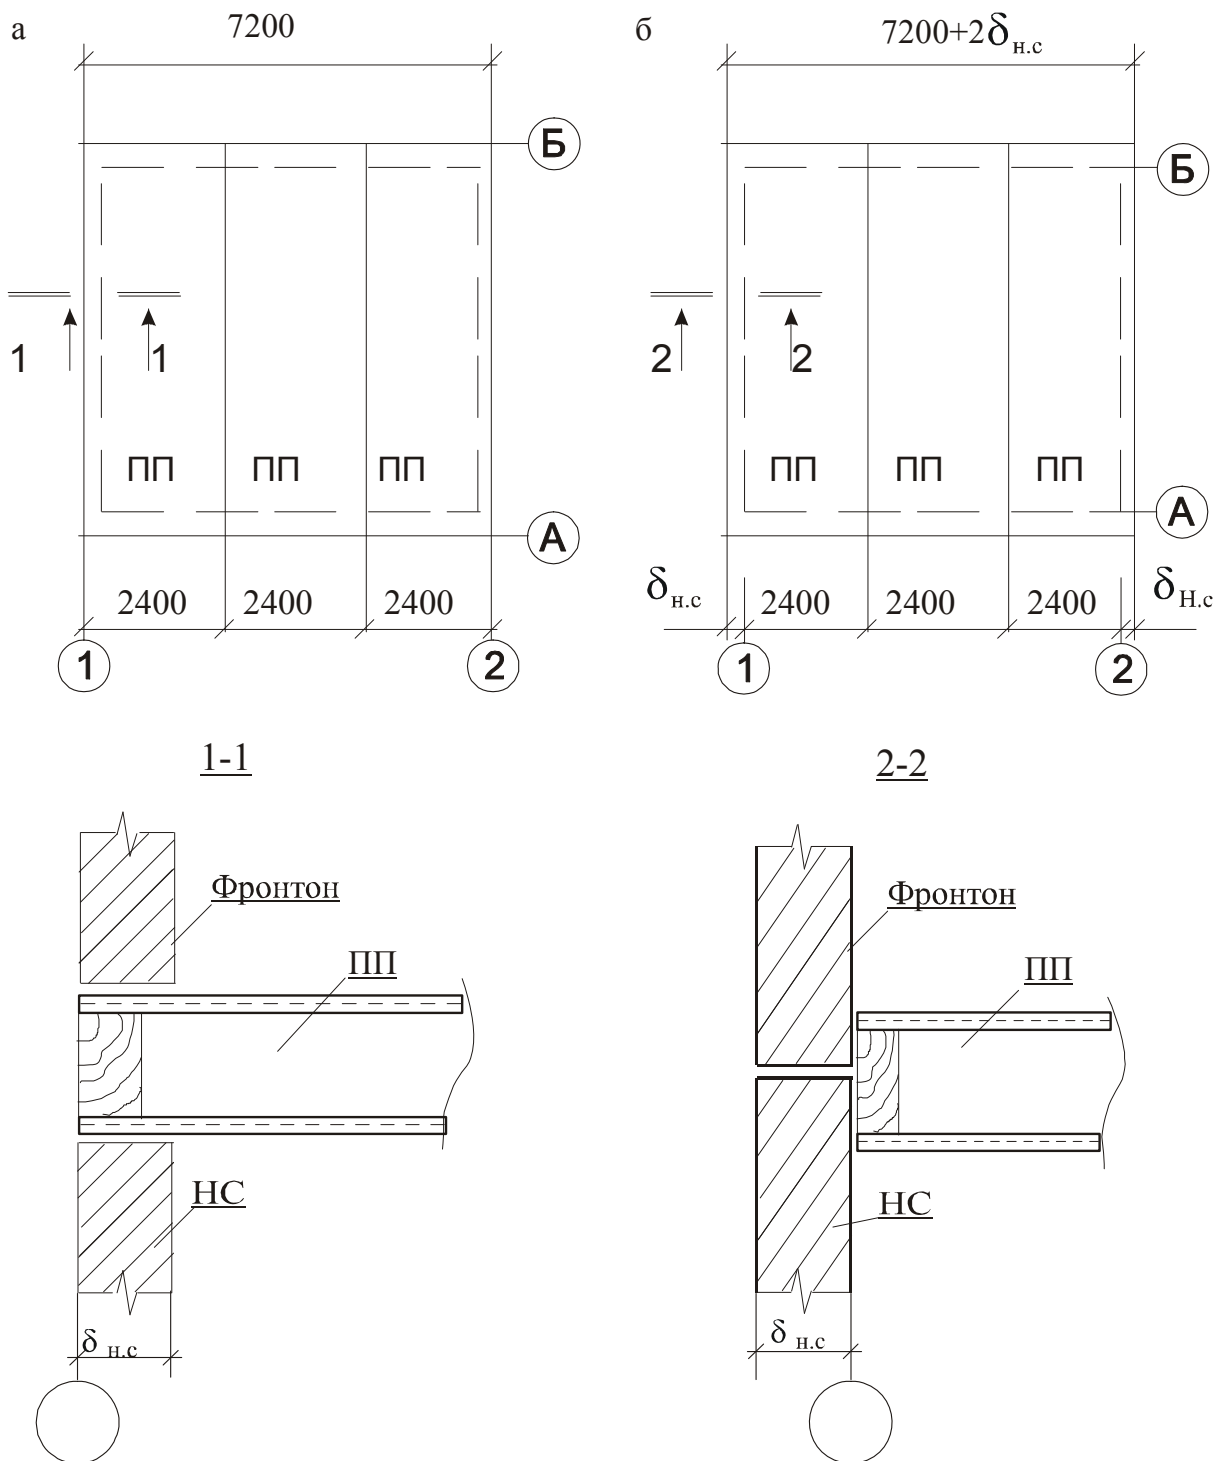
Варианты раскладки плит перекрытия (ПП). Узлы примыкания плит к фронтону и наружным стенам
